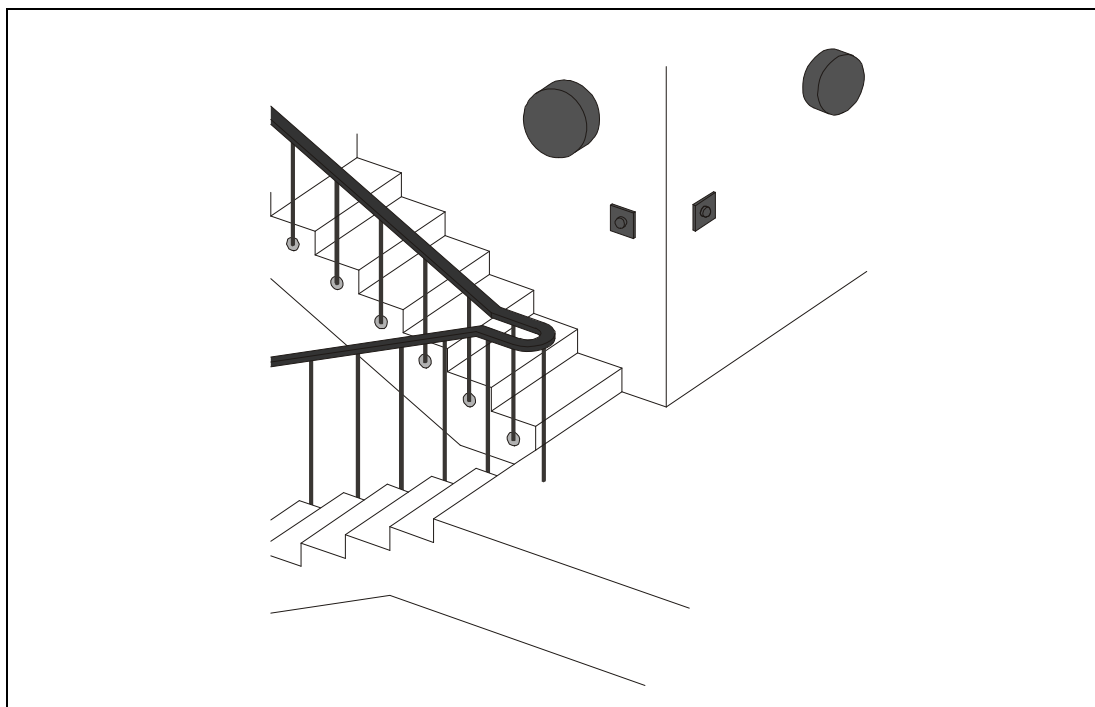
Prinzipskizze für ein Treppenhauslicht
